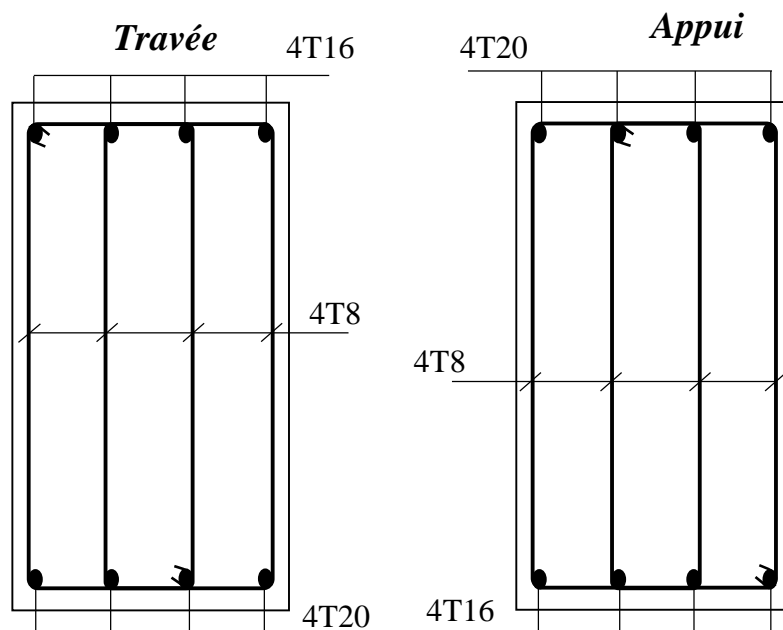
Schéma de Ferrailage des Poutres principale
